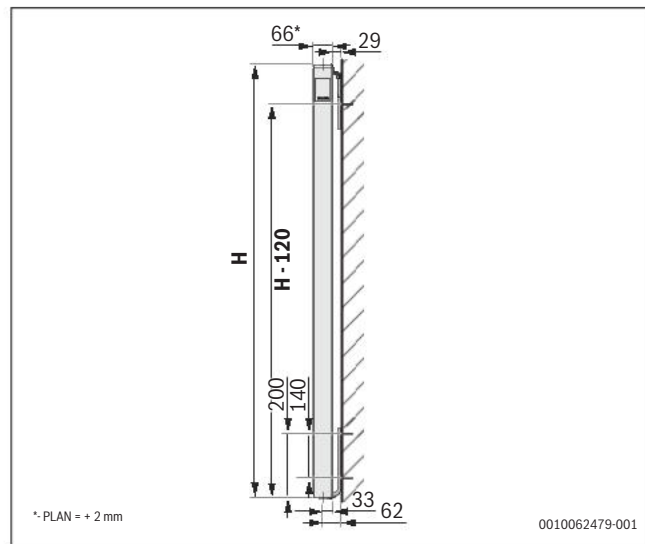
Vrsta instalacije radijatora 20 za CV Profil/ Plan.2
